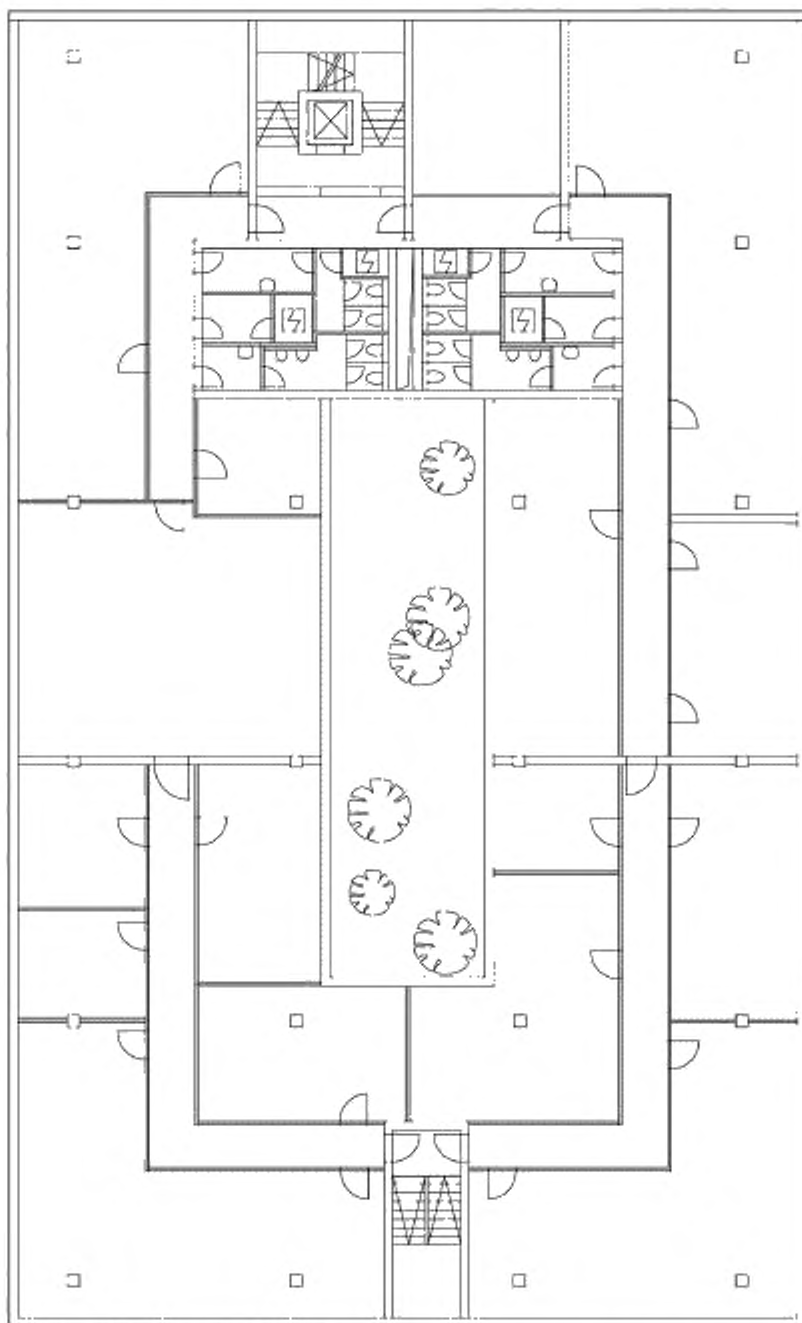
План этажа с указанием объектов, площадь которых входит в площадь перегородок
